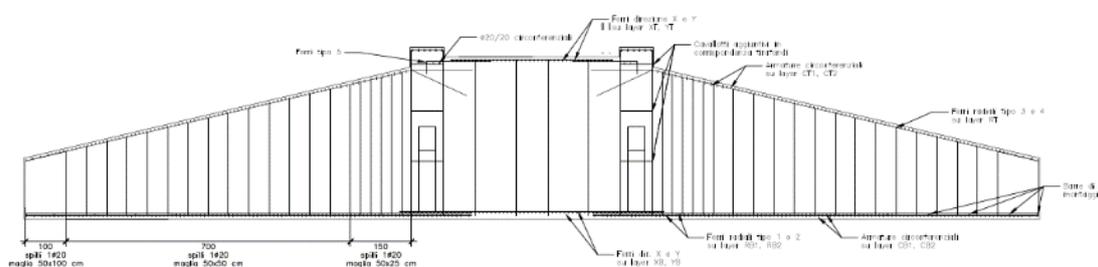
Sezione plinto di fondazione - identificazione armatura
